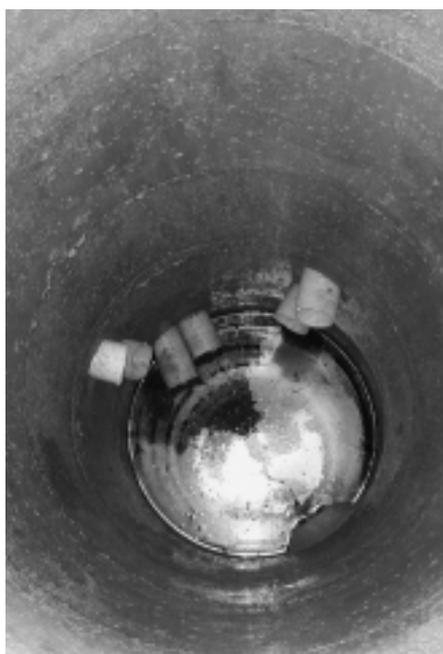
En France, il est obligatoire de prévoir un puits de regard quel que soit le type de fosse. Les conduites de drainage placées sous la dalle en béton débouchent dans un puits.
